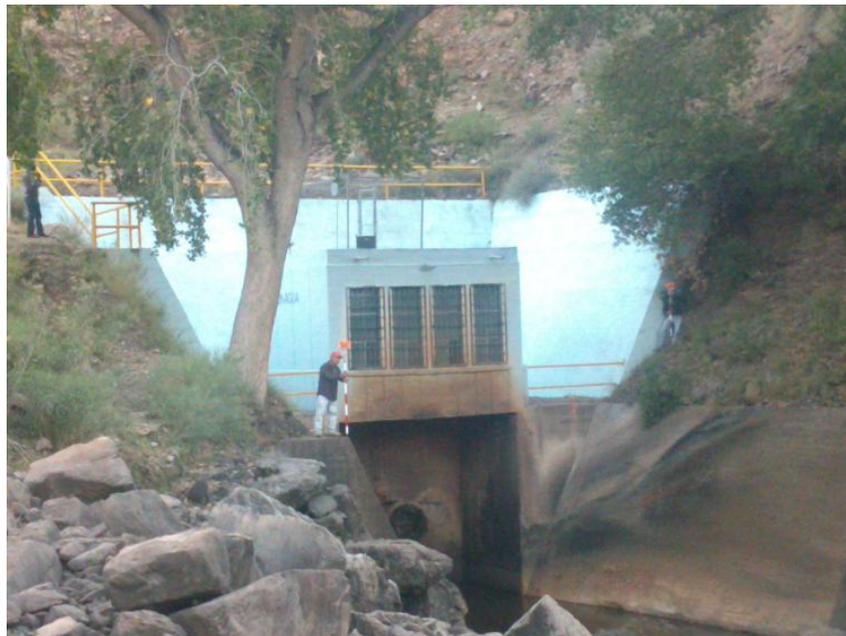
Levantamiento de la estructura de la obra de toma, Presa el Tintero, Namiquipa, Chihuahua.
